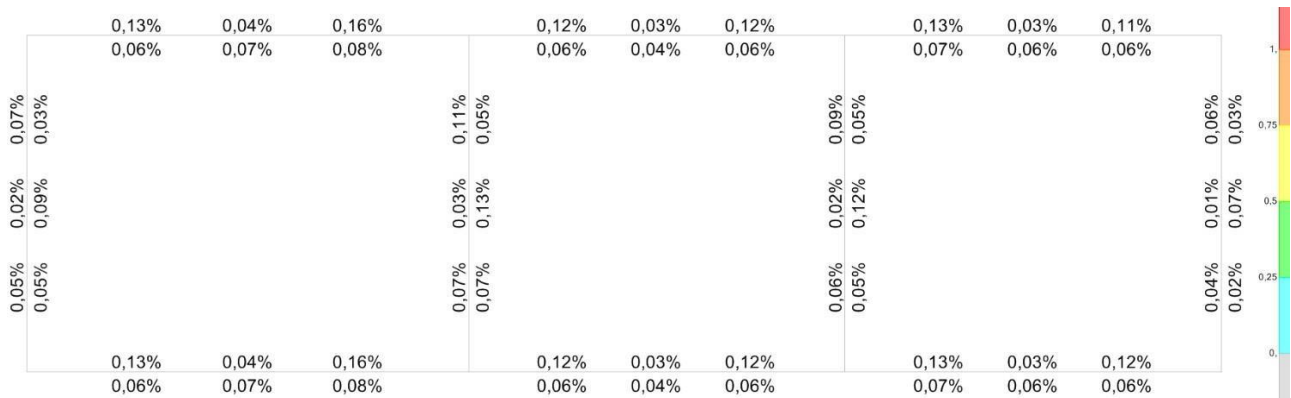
Porcentaje de Refuerzo Longitudinal Vigas Aéreas NE+5.40
